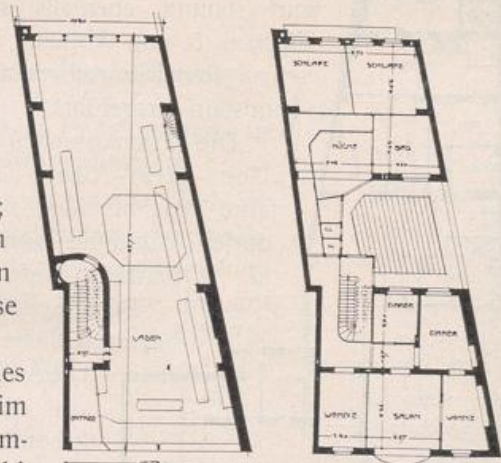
Schadowstrasse 23. Erd- und Obergeschoss. 1:500.
